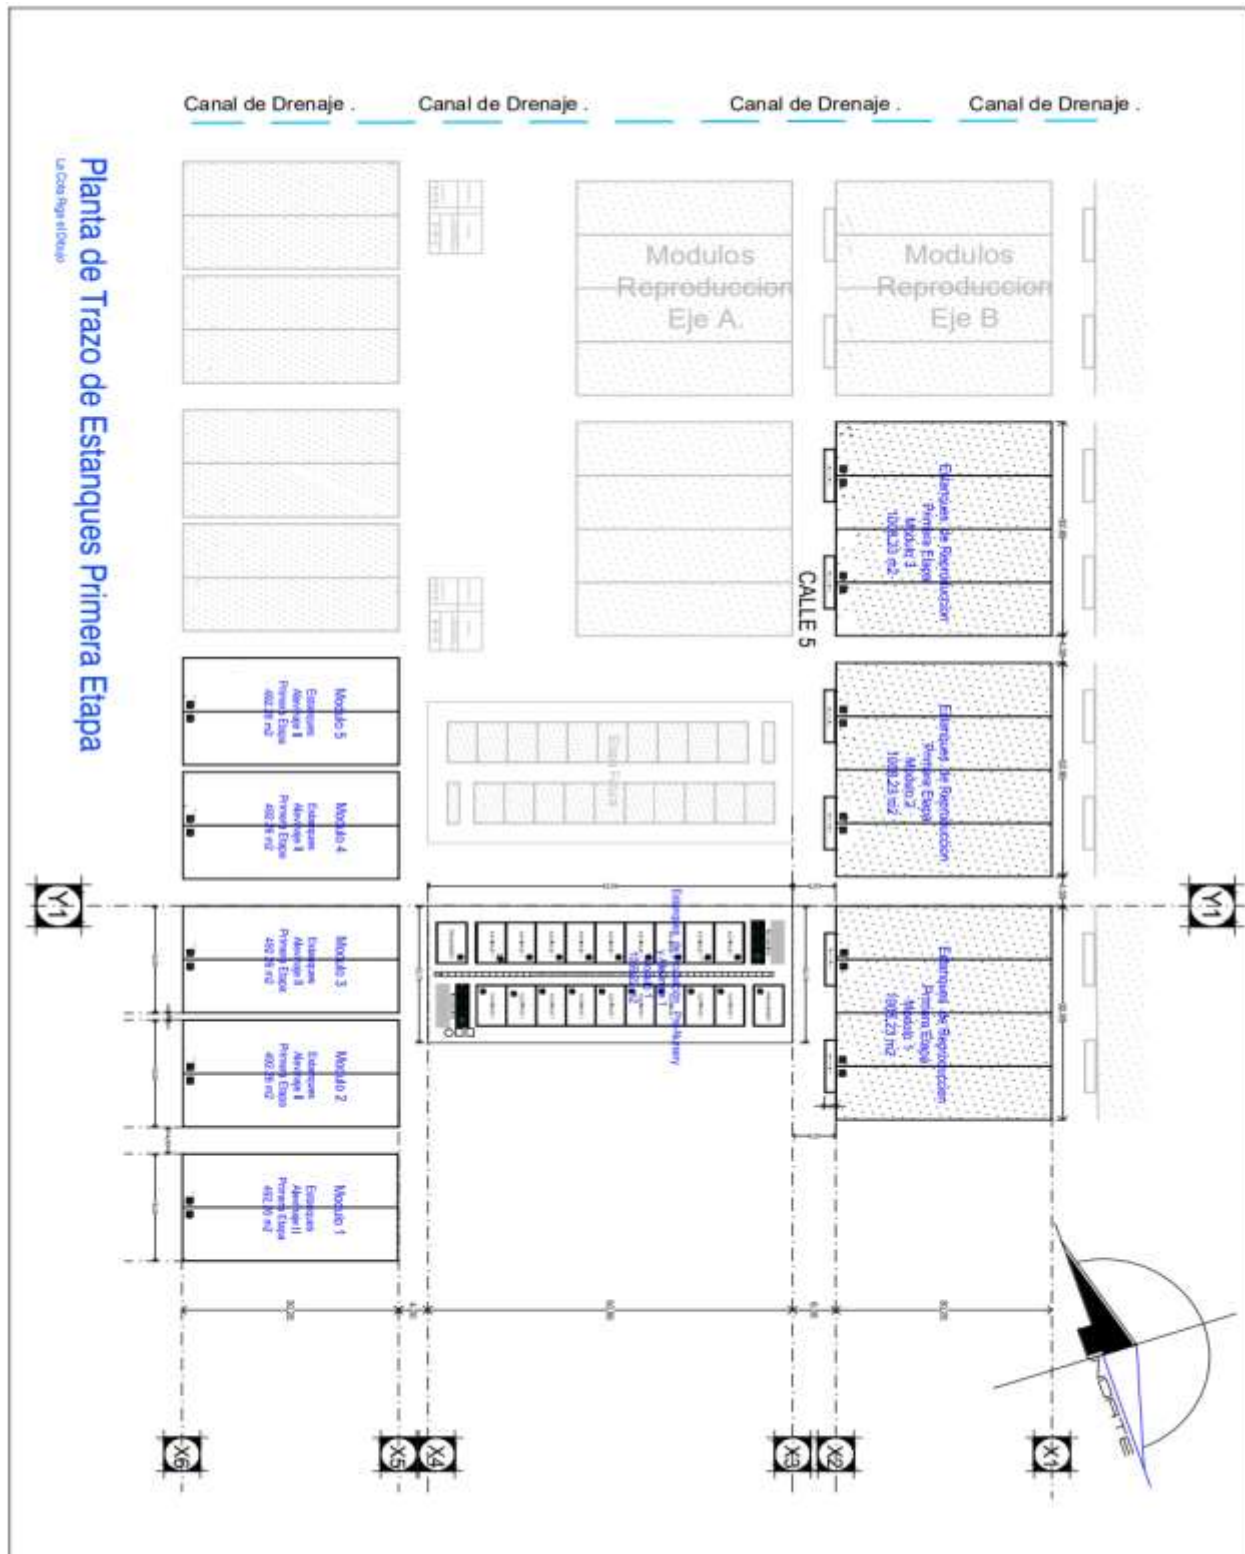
Anexo 2. Planos de los estanques para la primera etapa, 2025.
